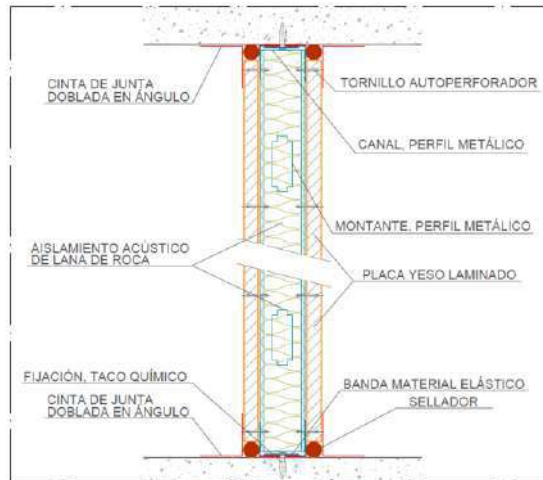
Detalle de propuesta de tabique divisor zona seca con zona seca. 2016. Fuente Propia
